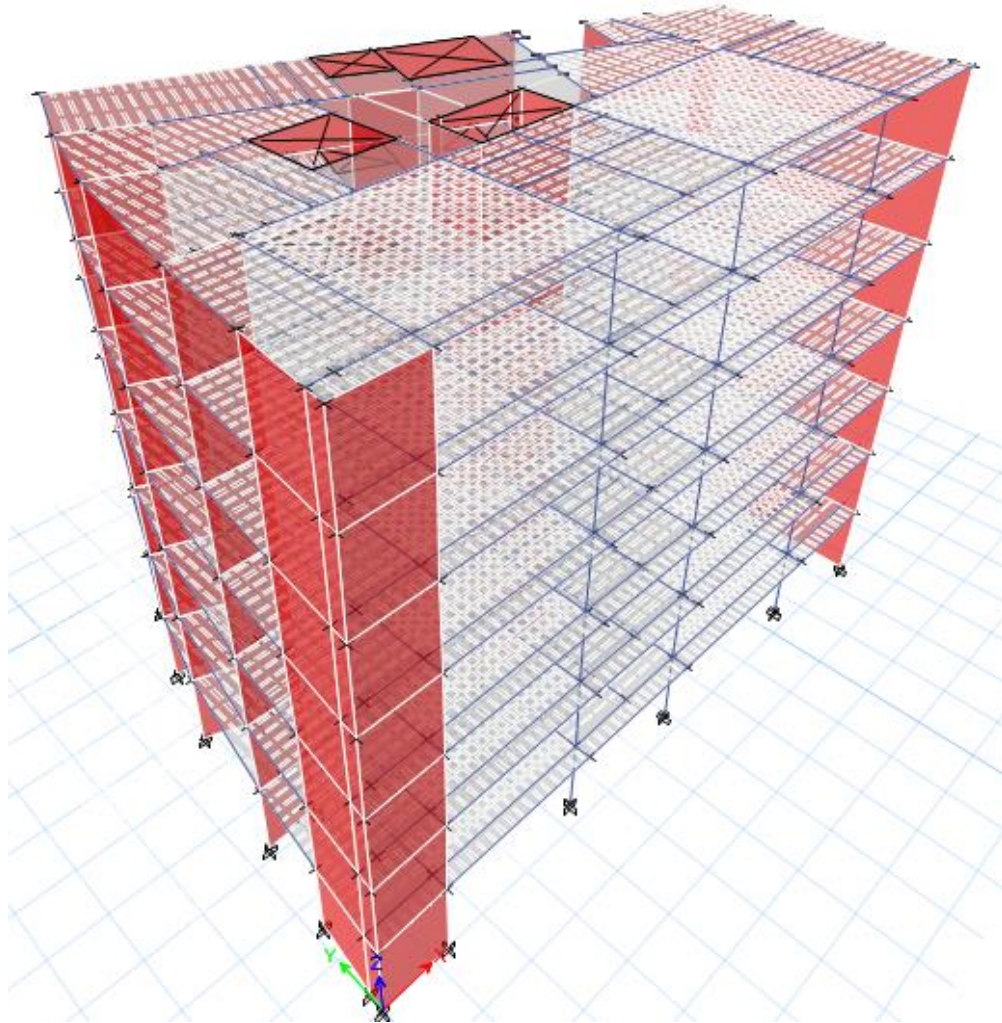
Modelo de la edificación convencional – Sistema de Muros de Concreto Armado
